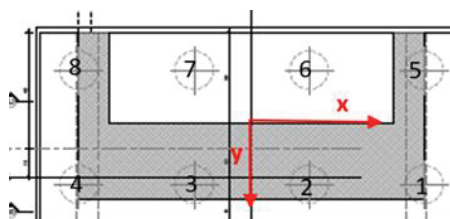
Sistema di riferimento per le fondazioni delle spalle con indicazione della numerazione dei pali
